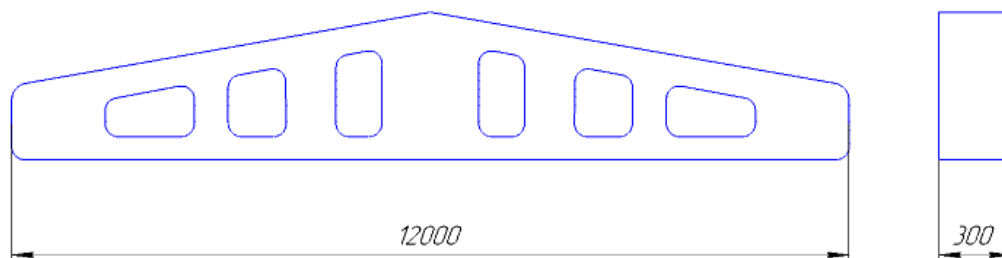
Габаритные размеры железобетонной фермы
